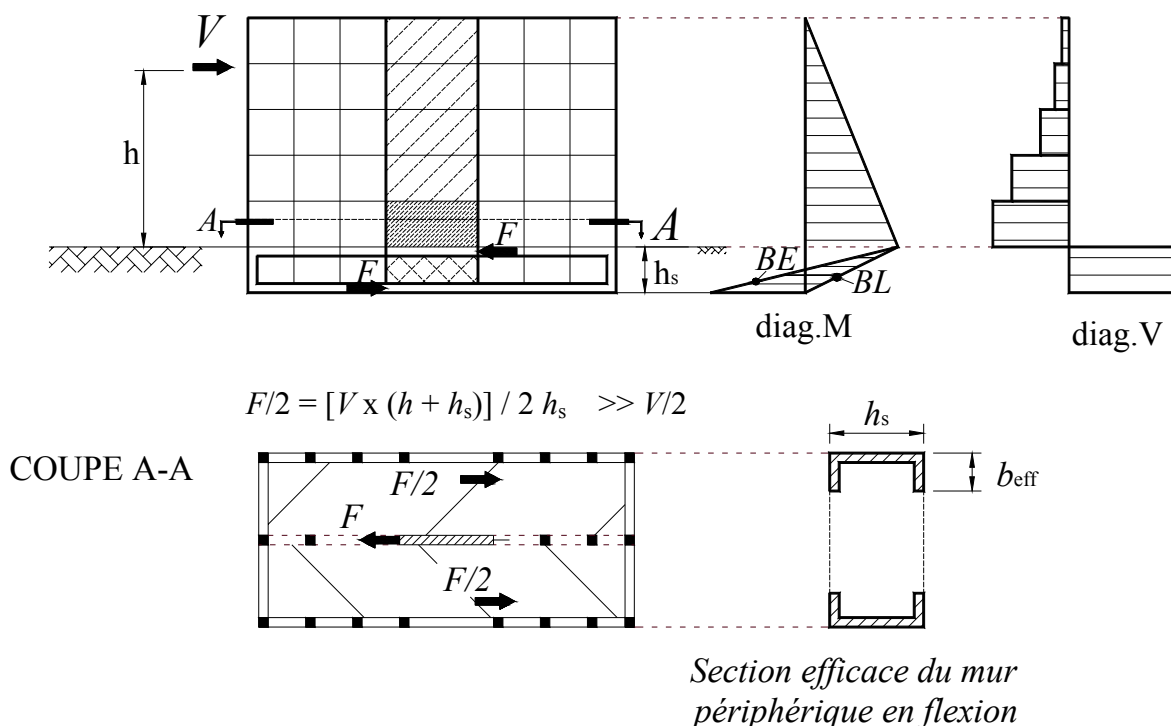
Si les contreventements sont dans les plans des façades, les voiles périphériques en sous sol constituent automatiquement des poutres raidées assurant un encastrement.
